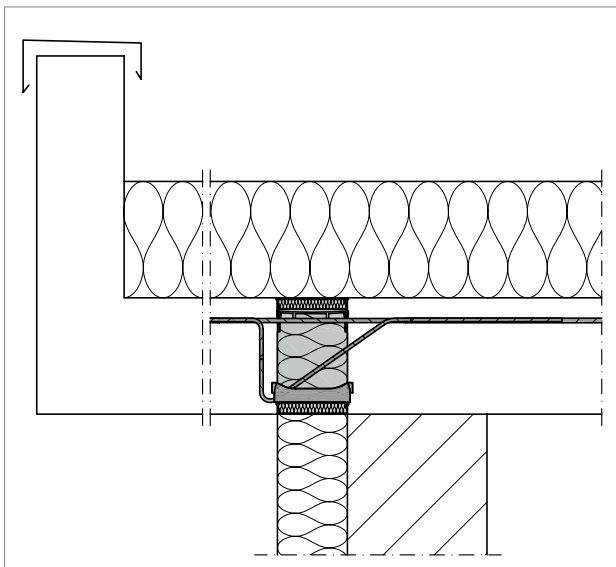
Schöck Isokorb® XT Typ K: Anschluss eines Vordachs
